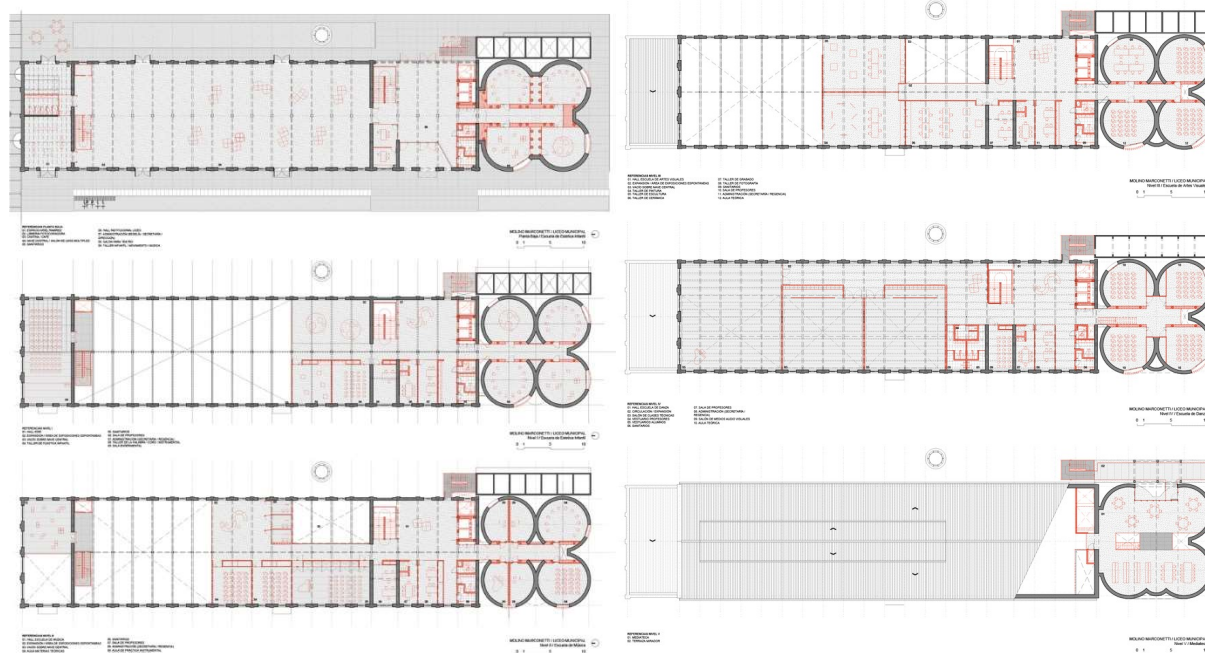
Plantas baixas do Liceu Municipal Molino Marconetti, Santa Fé.
